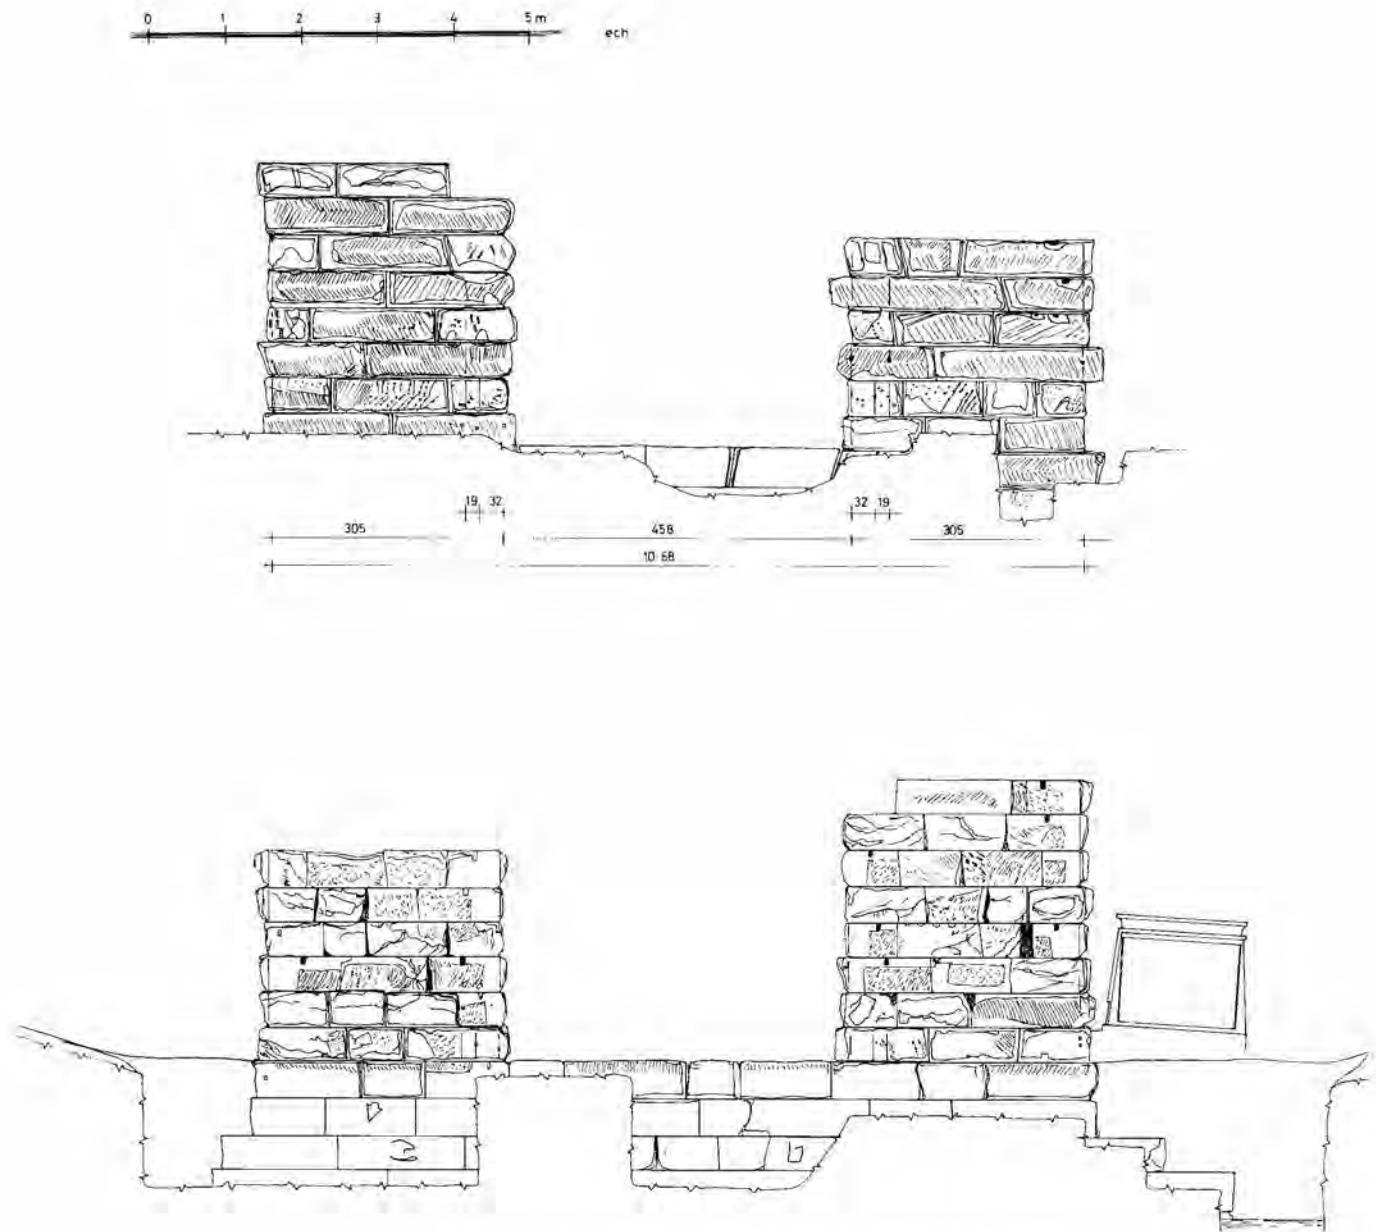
Porte P : élévation des façades ouest et est avec amorce de la rampe.
